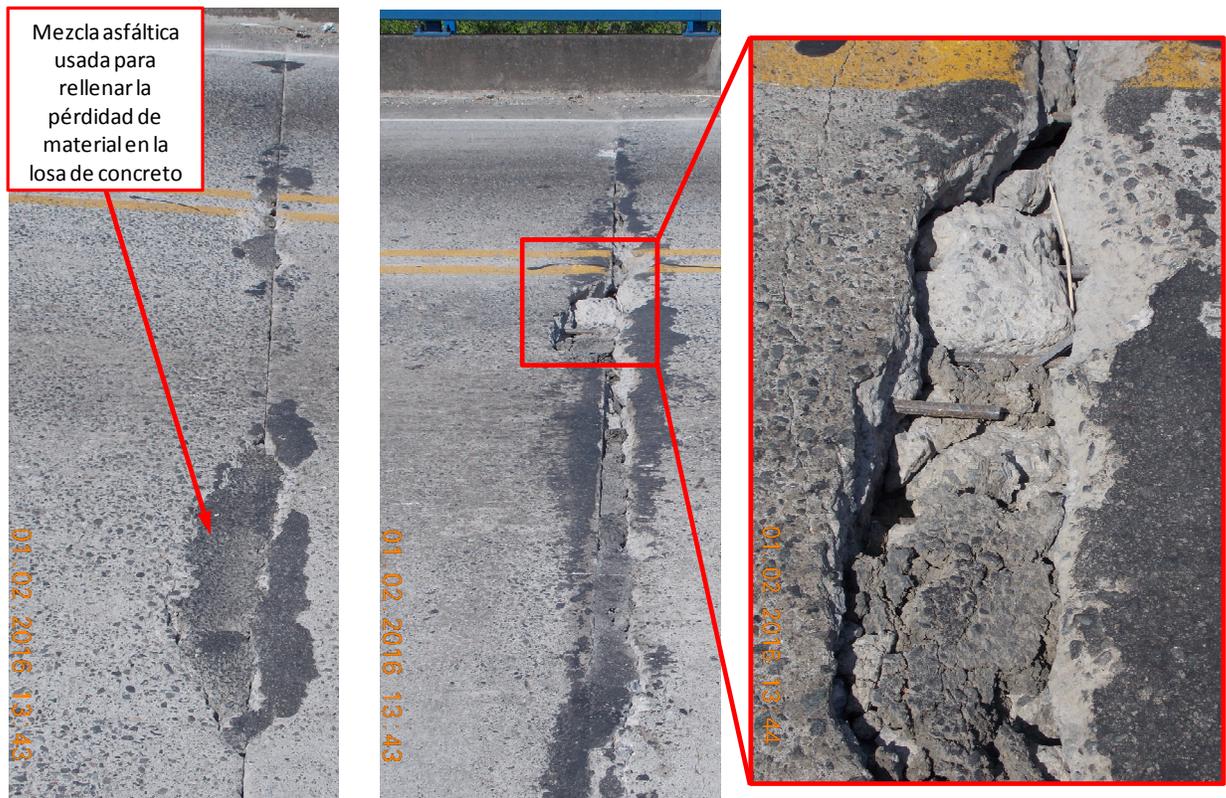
Puente sobre la quebrada Salitral. Deterioro de juntas de construcción: Izquierda: uso inadecuado de mezcla asfáltica para rellenar la pérdida de concreto en la losa; Derecha: desprendimiento de concreto y evidencia de falla transversal del acero longitudinal de la losa
